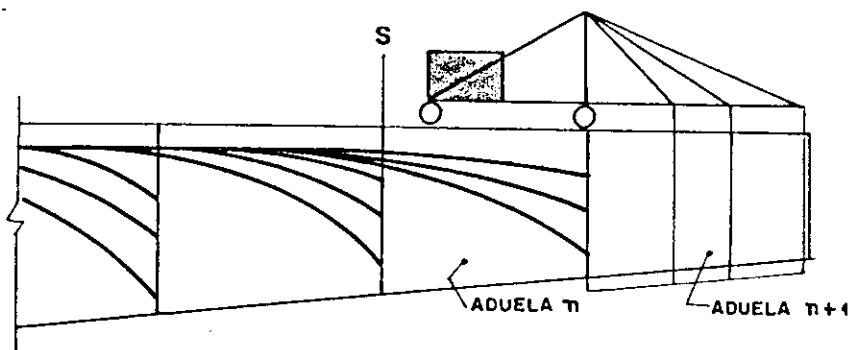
SITUAÇÃO DE CARREGAMENTO PARA
